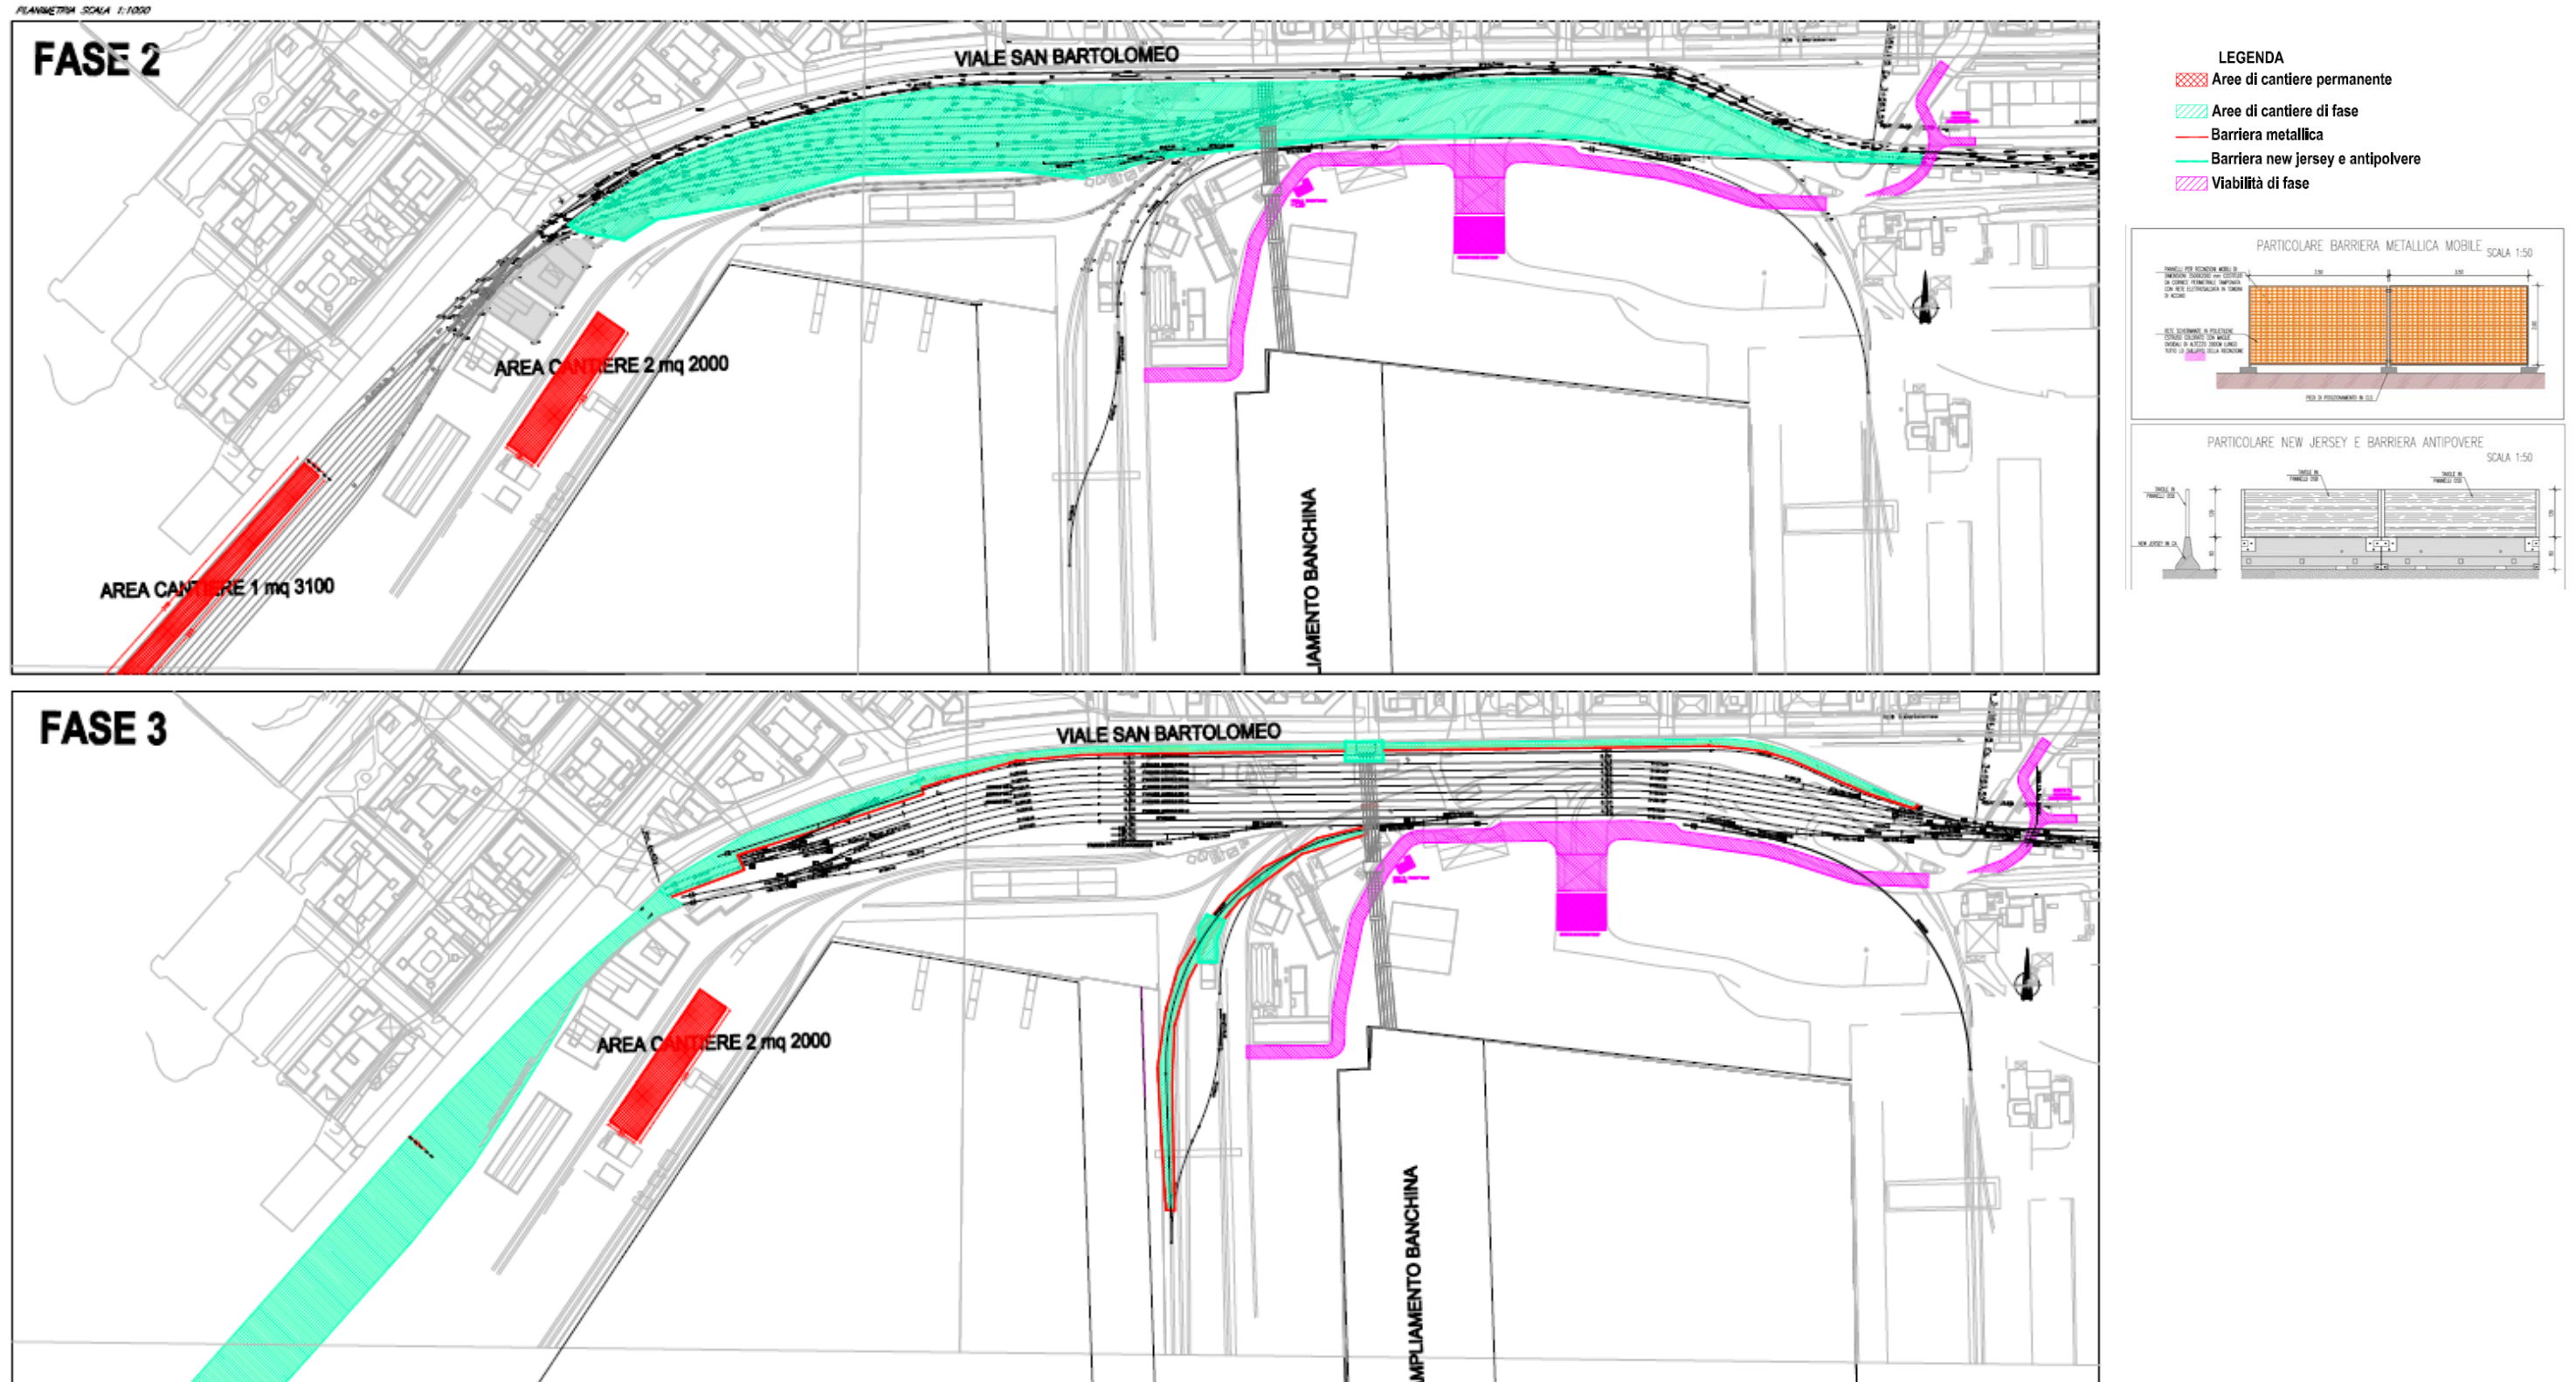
Planimetria con indicazione delle fasi realizzative – Fasi 2 e 3
